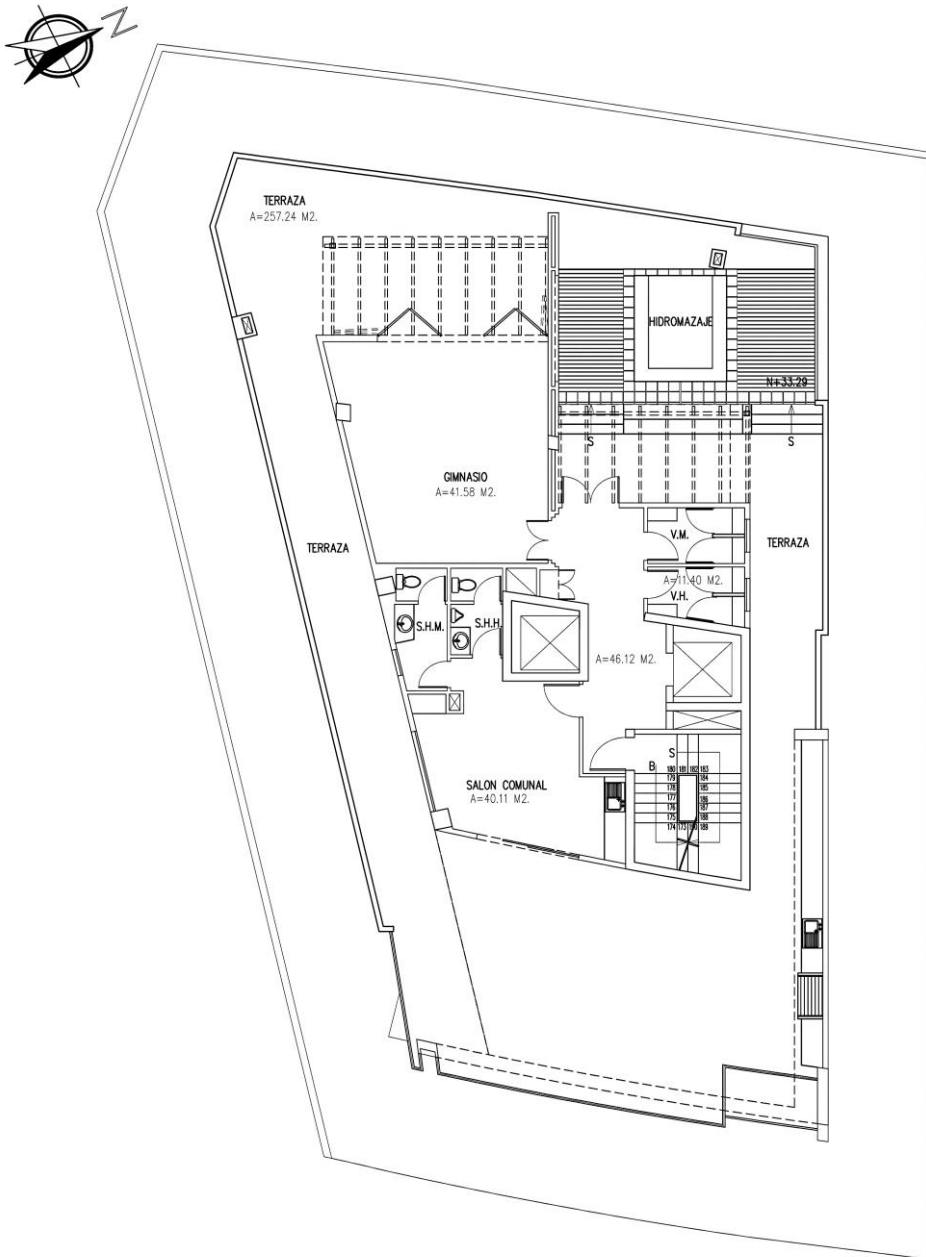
Planos Arquitectónicos Edificio Boheme – Planta Comunal
